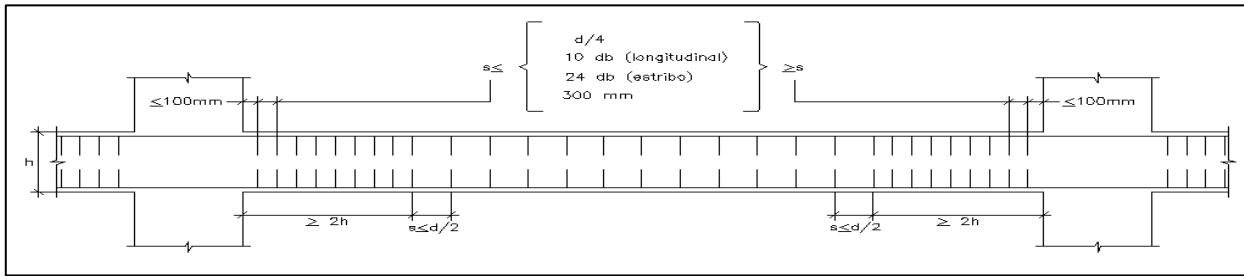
Requerimientos para el espaciamiento para vigas sísmicas en edificios con sistema de muros estructurales.
